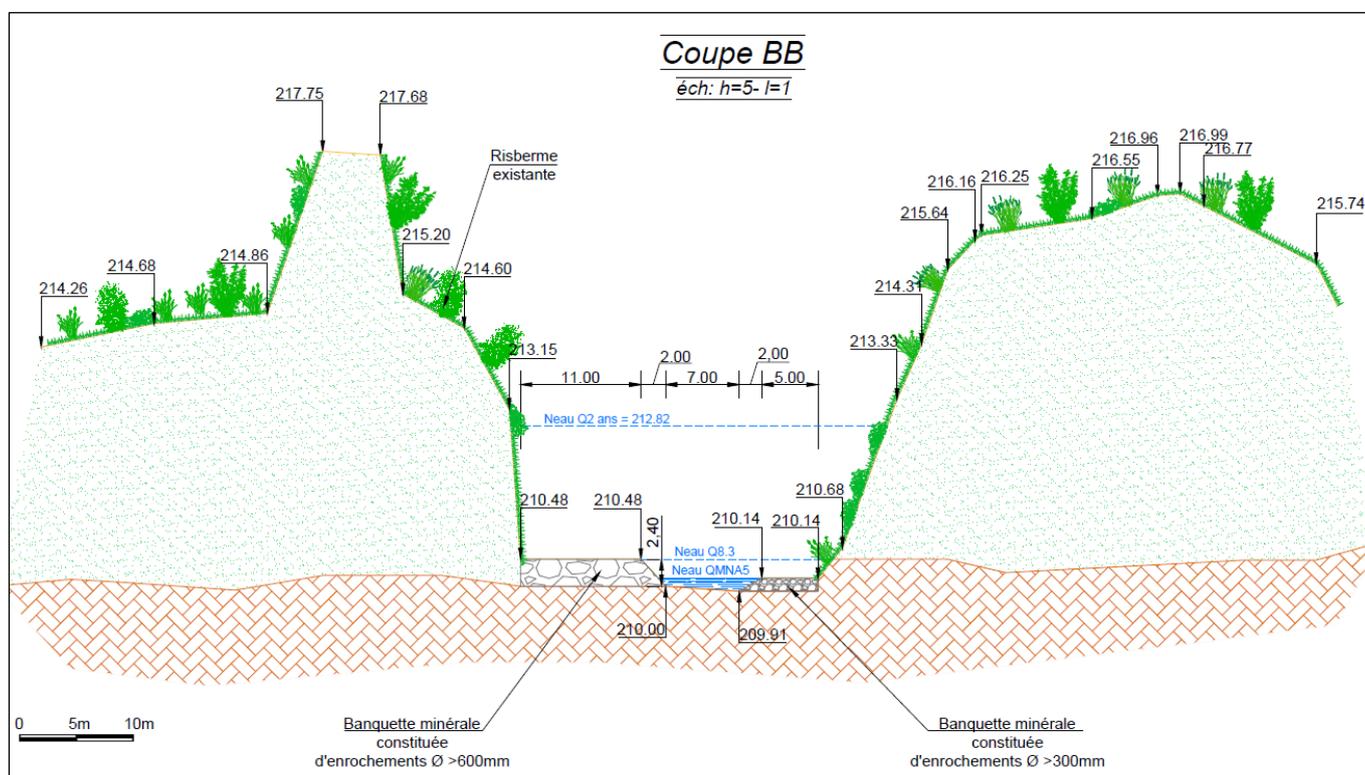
Coupe type des banquettes 1 et 2 au droit du chevauchement
